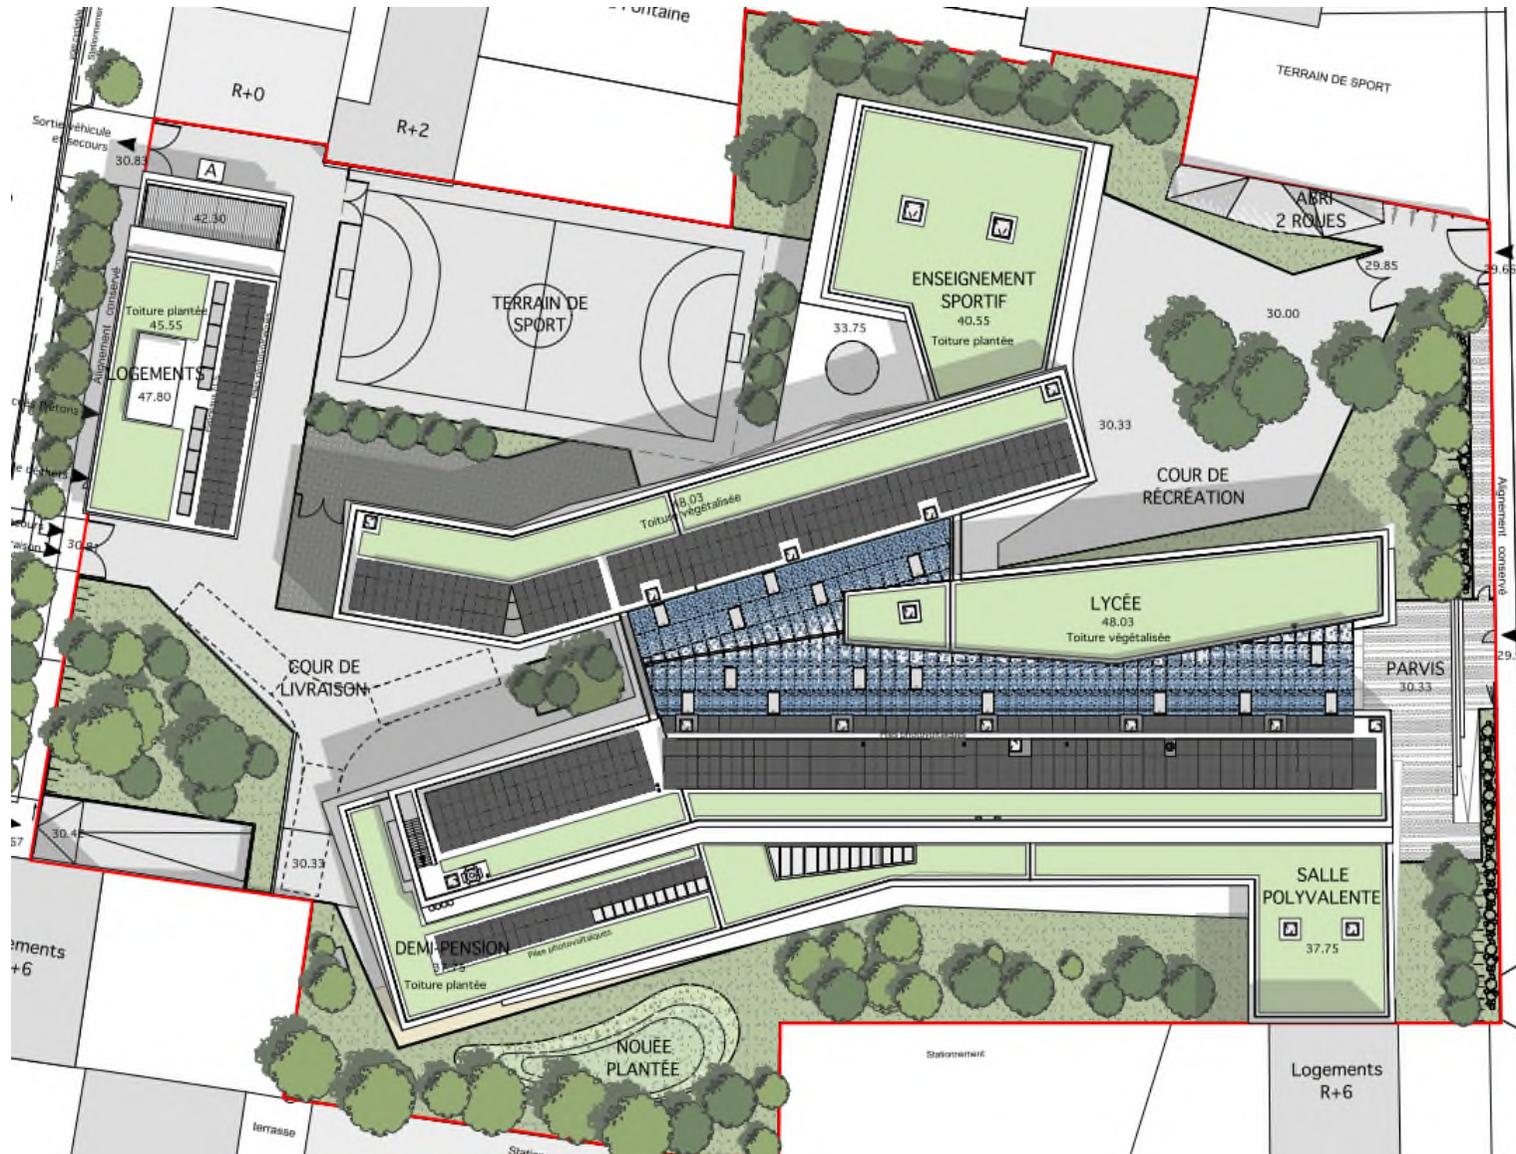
Plan masse / APD 2/2 (source : Epicuria)
